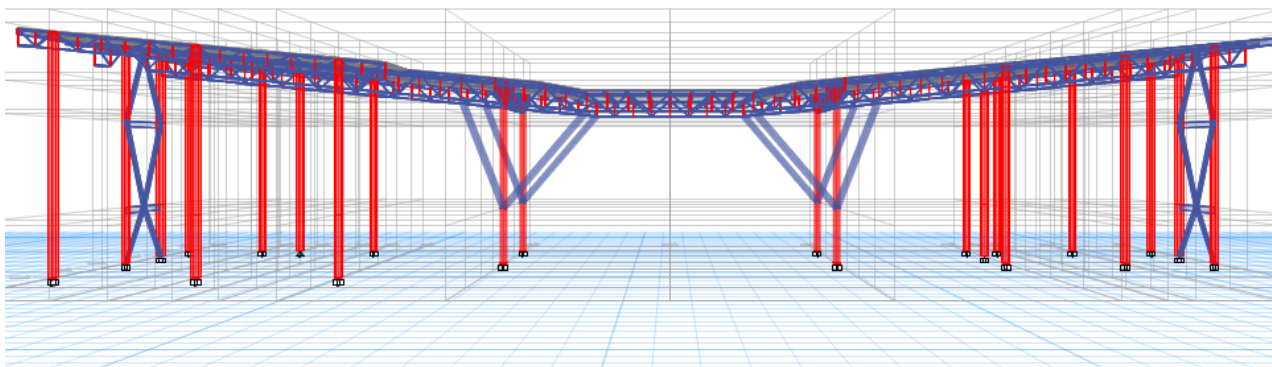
Elevación X-Z 3D Estructura de armaduras.
